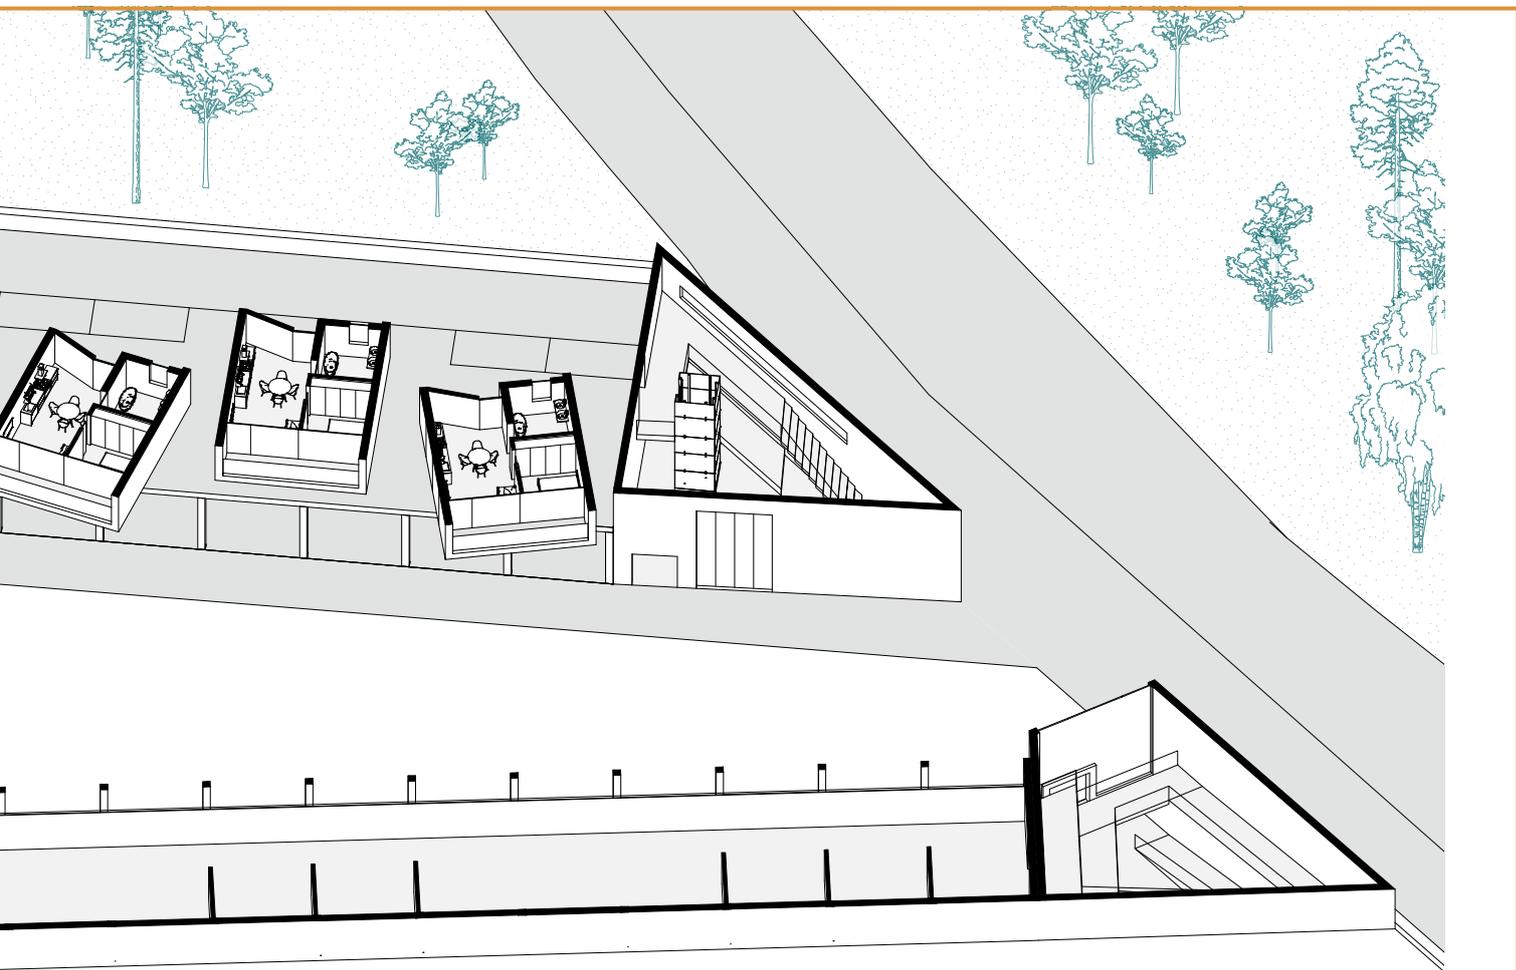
Vista prospettica e pianta assometrica edificio SEQUENZA III, disegni fuori scala.
